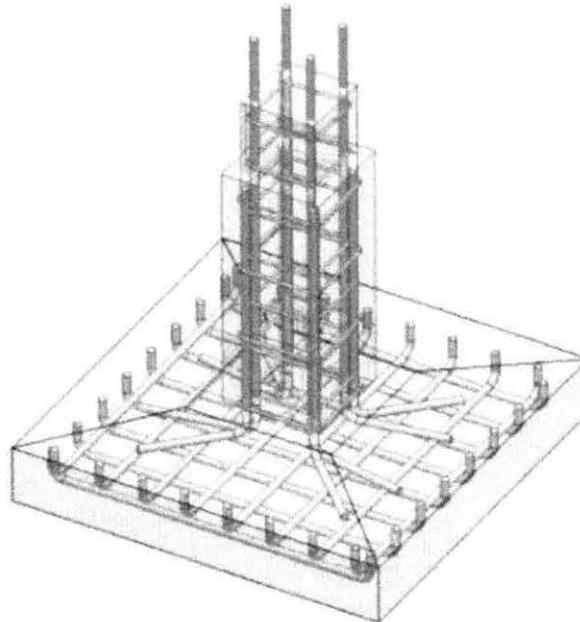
Esquema recomendado de zapata de cimentación.
